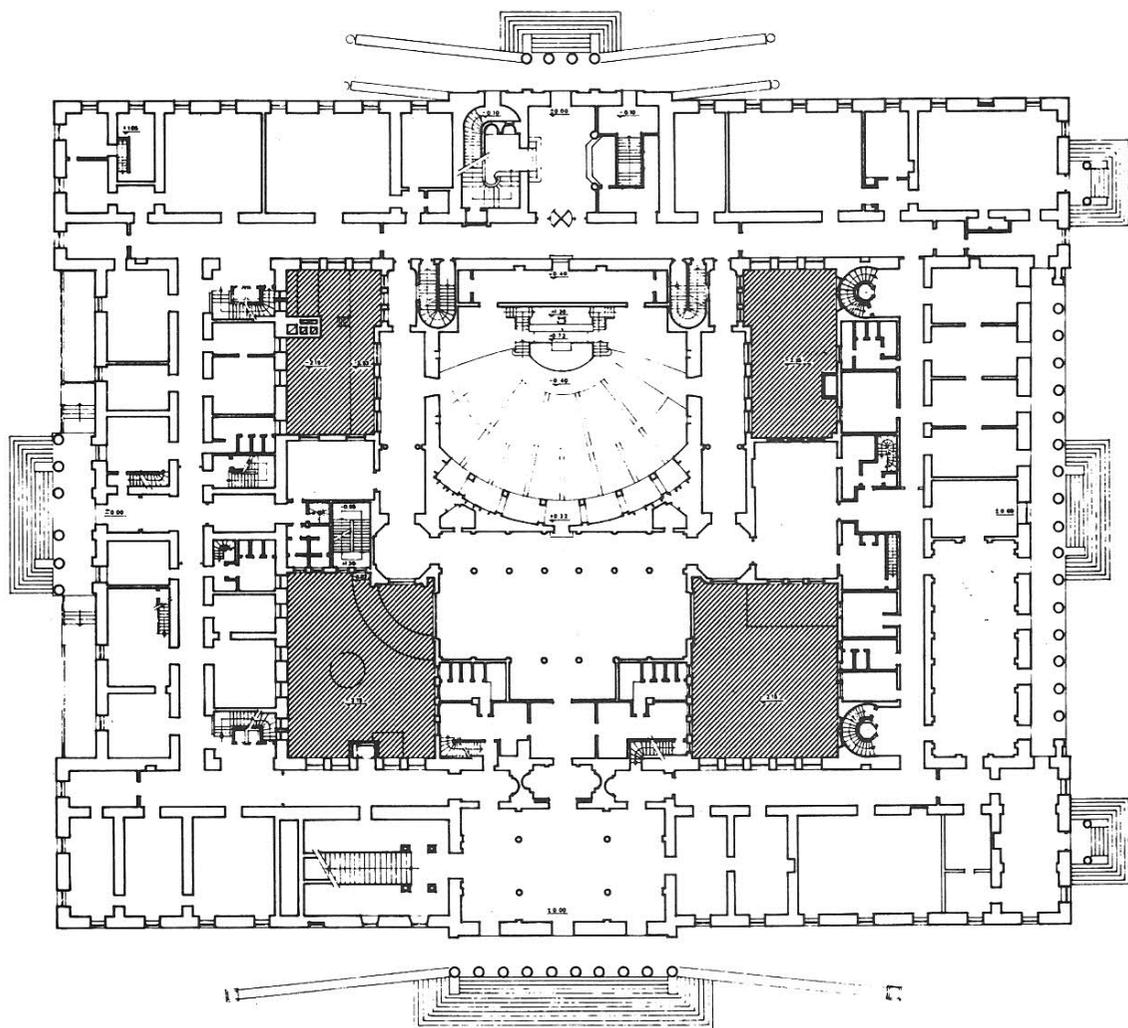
Grundriß des Erdgeschosses der Athener Residenz. Heutiger Zustand, nach dem Umbau zum Parlamentsgebäude (1929-1934)
